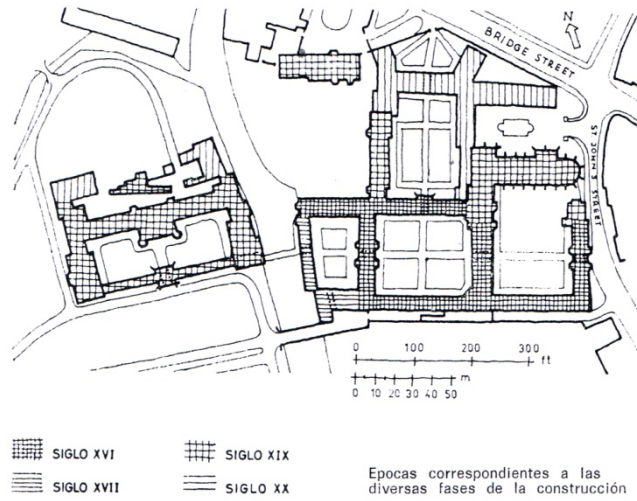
Planta do Campus Universitário St. John's, Cambridge e as diferentes fases de construção
